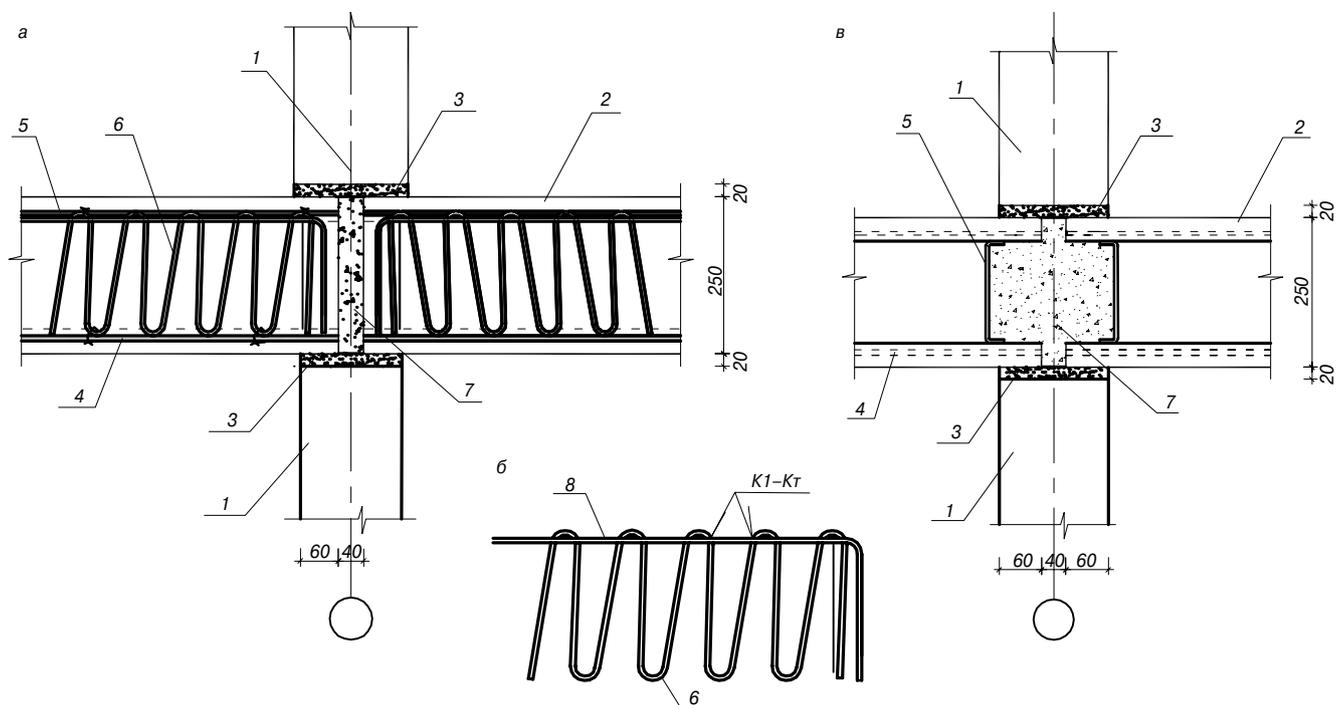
Стык внутренних стеновых панелей с многопустотными плитами перекрытий: а – сечение по ребру плиты в опорной зоне; б – каркас армирования вертикального ребра плиты в опорной зоне; в – сечение по полке плиты: 1 – внутренняя стеновая панель; 2 – многопустотная плита перекрытия; 3 – растворный шов; 4 – рабочая арматура нижней зоны плиты; 5 – конструктивная арматура верхней зоны плиты; 6 – каркас-змейка; 7 – монолитный бетон; 8 – верхний дополнительный арматурный стержень каркаса
